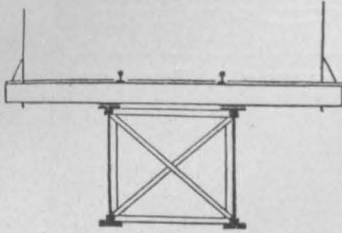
Bahn oben. Große Bauhöhe. Unmittelbare Lagerung der Querschwellen auf den Hauptträgern.
